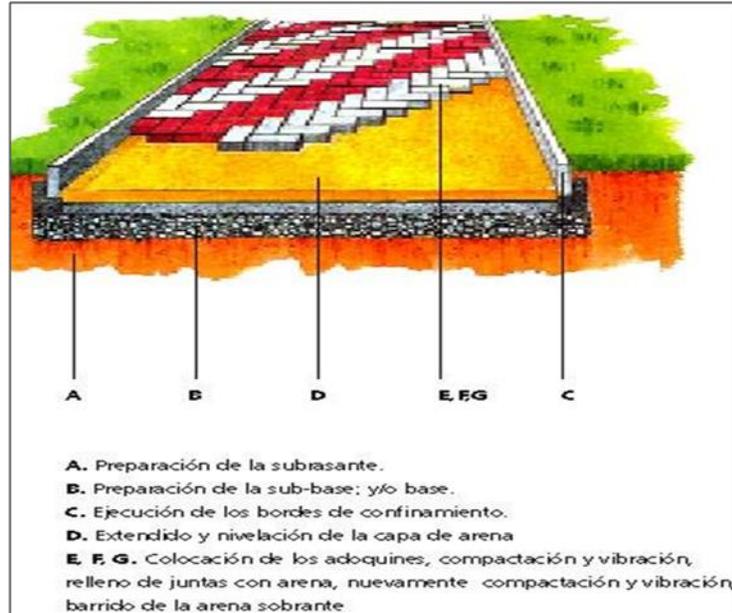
Esquema general del Pavimento Articulado (Adoquinado). Fuente: Ing. Jorge Córdova, Pavimentos, 2013
